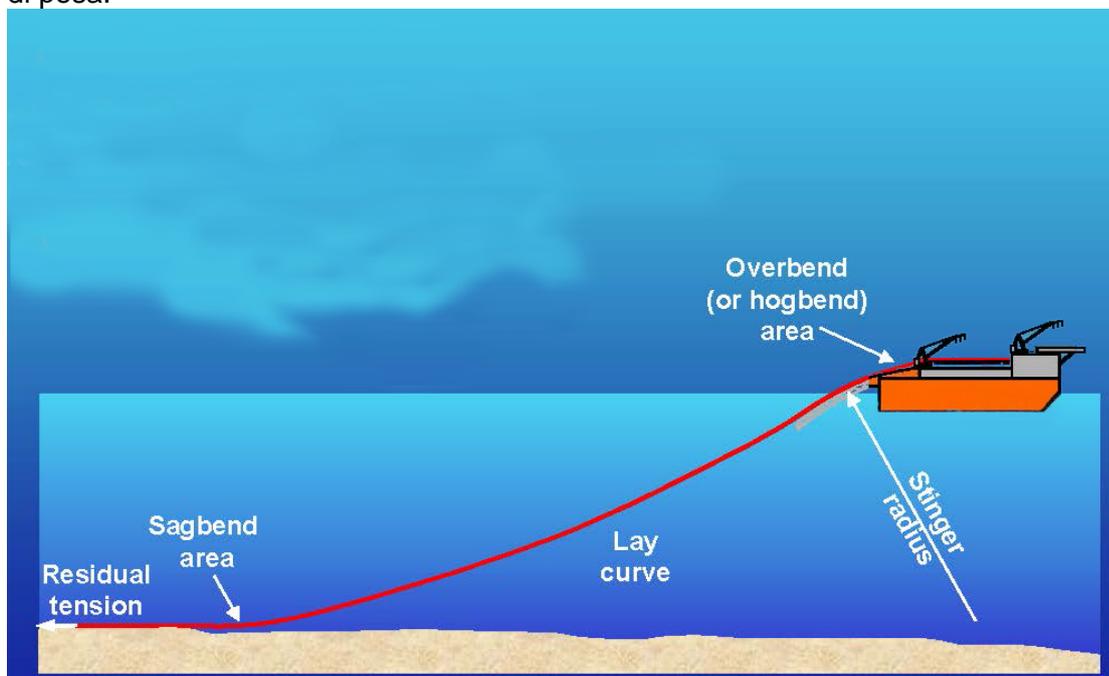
Disposizione generale a "S-lay" - Disposizione tipica
